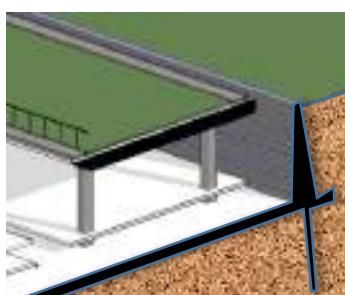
Ilustrasi Retaining wall sebagai penahan kapur terletak dari dasar bangunan hingga podium.
